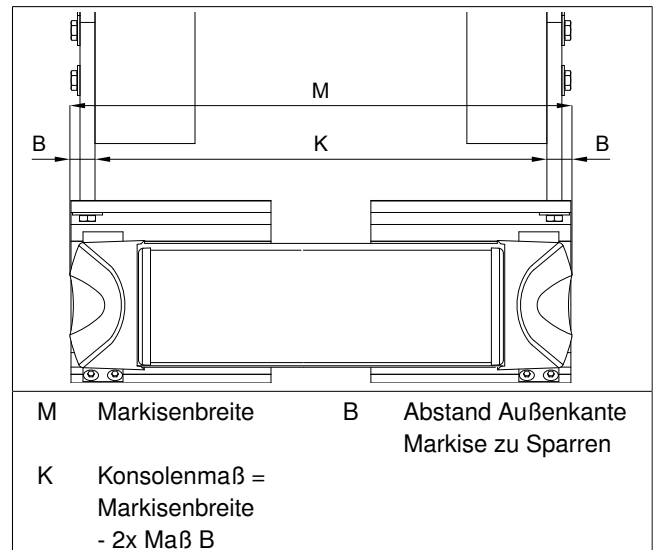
Maß-Skizze für Konsolenposition (am Beispiel Dachsparrenmontage)
